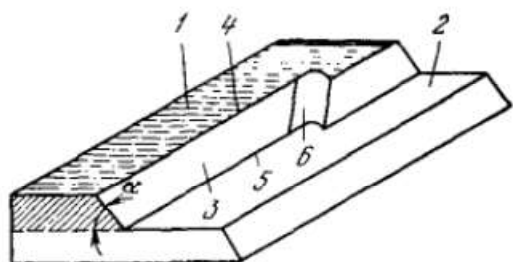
Схема уступу: 1 – верхня площадка уступу; 2 – нижня площадка уступу; 3 – укіс уступу; 4 – верхня бровка уступу; 5 – нижня бровка уступу; 6 – забій уступу
